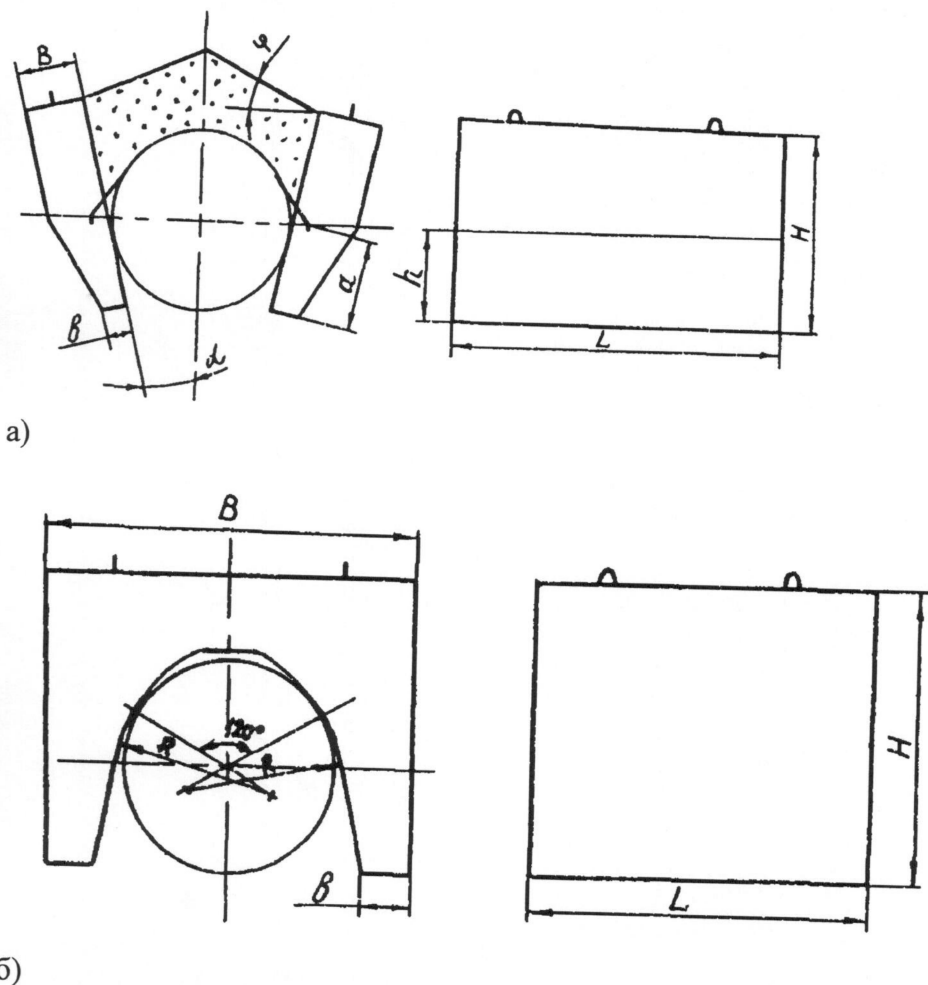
Схемы конструкций железобетонных утяжелителей:
